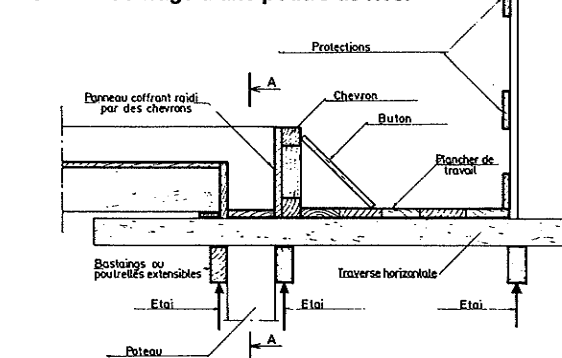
bis. - Platelage pour fond de poutre et passerelle de circulation.
